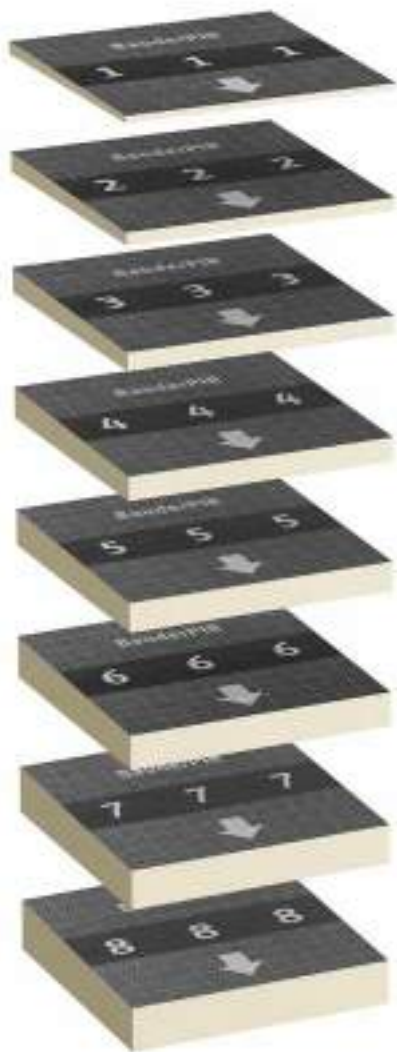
/2: Príklad kladenia BauderPIR T GGP protispádových dosiek
